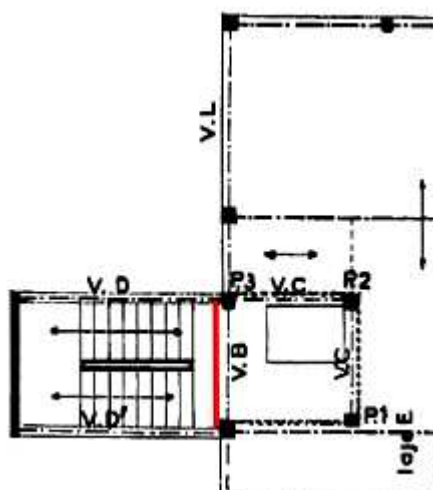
Pormenor da caixa de escadas e da estrutura principal adjacente (adptado de Milheiro, 2008)
